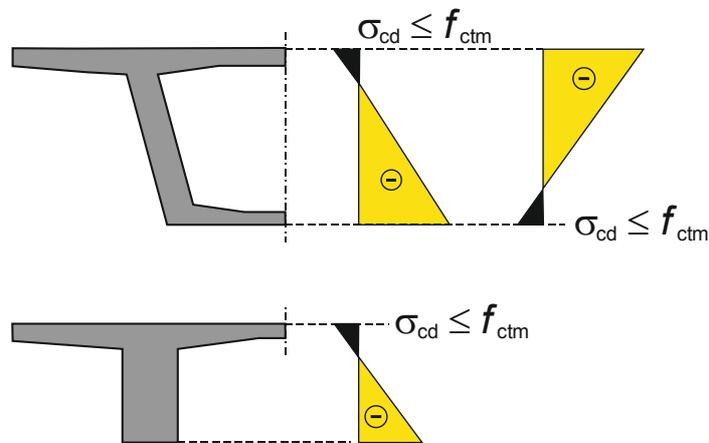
Querschnittsbereiche mit in der Zugzone liegendem Gurt
